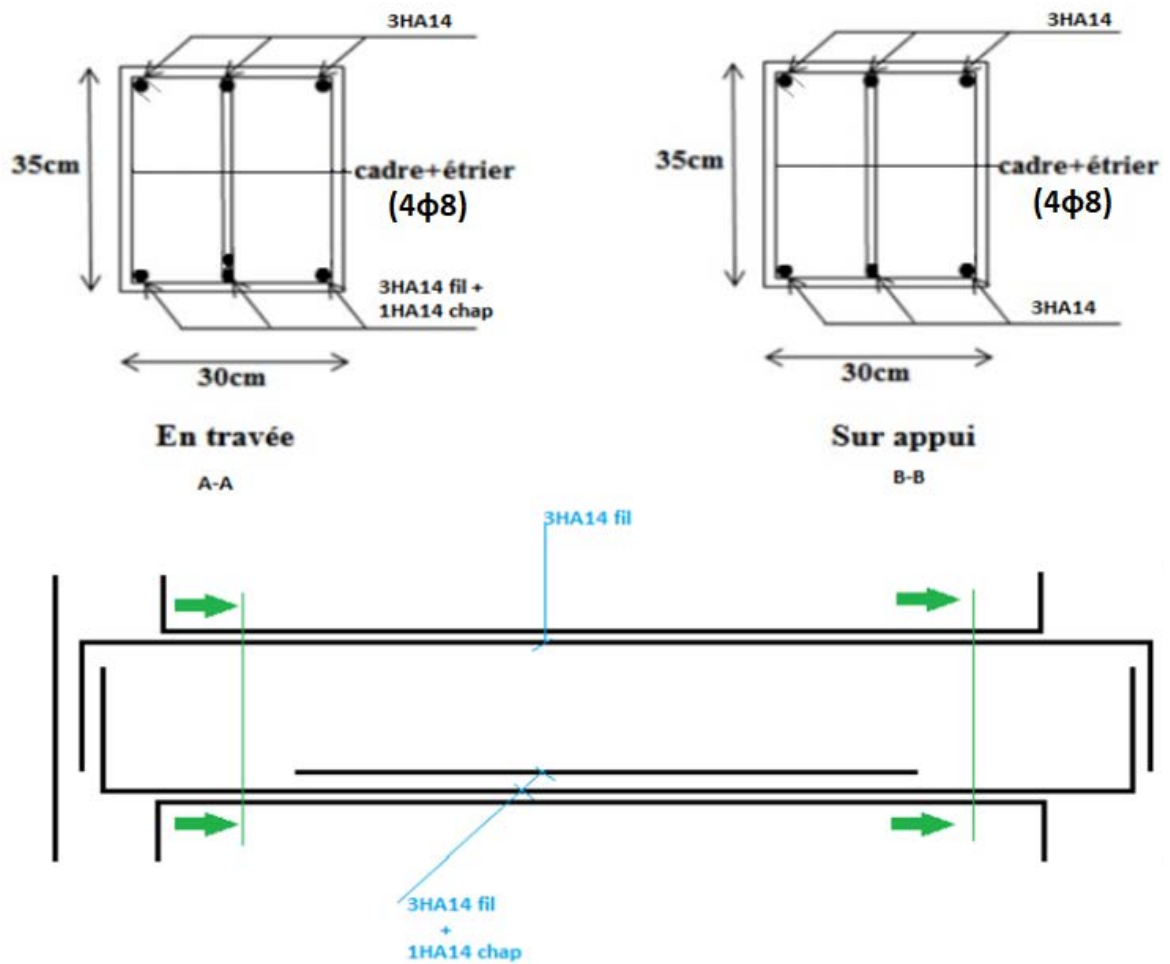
Croquis de la poutre palière sur appui et en travée
